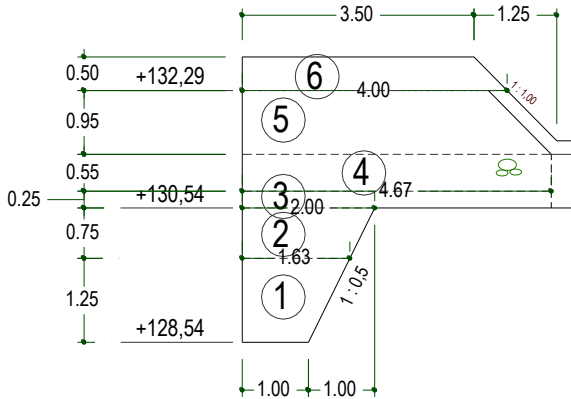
13 Groundsill Tampak Depan (Pasangan Batu)
